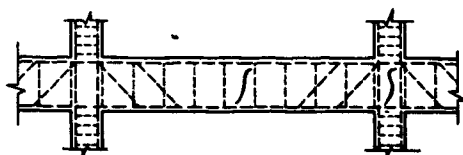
Grietas de retracción en viga fuertemente armada. Al aparecer cerca de los apoyos pueden situarse oblicuamente, con lo que se asemejarían mucho a grietas producidas por cargas. La grieta no pasa la línea de la armadura. Citado por Bukowski¹.
